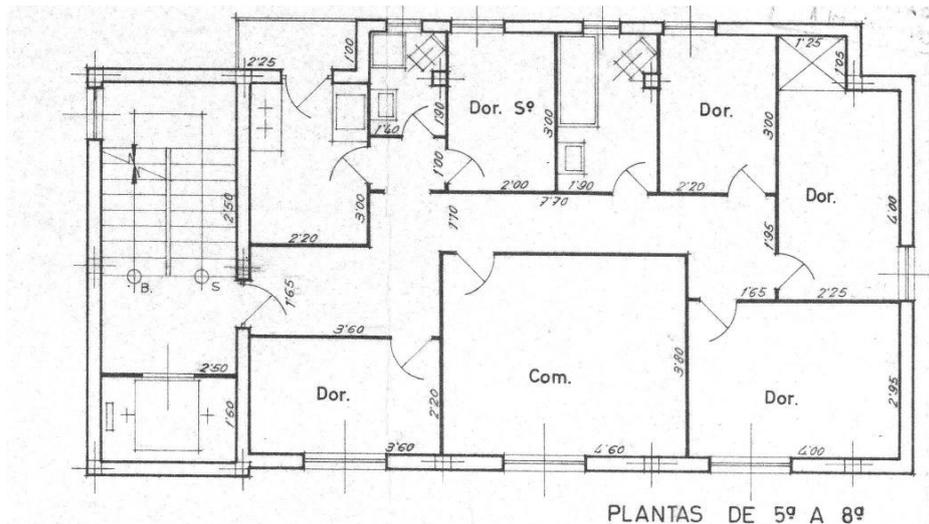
Planta de tipo residencial de la torre. Fuente: Fragmento del plano original de Carlos Balmori. Archivo Municipal de Valladolid.
